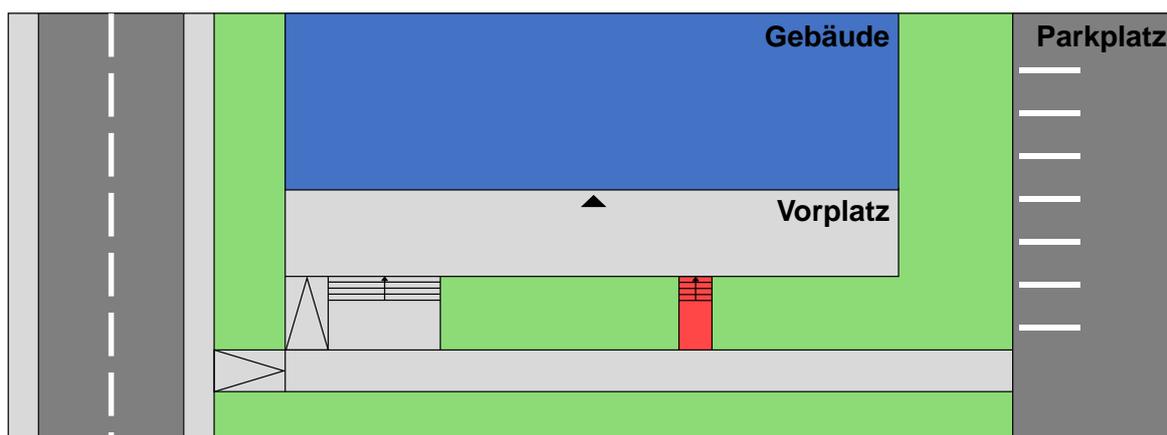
Beispielhafter Lageplan eines Gebäudehaupteinganges
